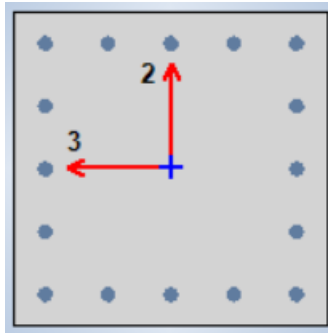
Esquema de columna utilizada (obtenida de ETABS).
